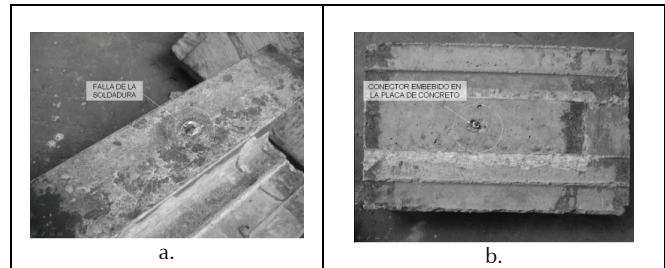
Falla de la soldadura. a) Ruptura de la soldadura en la base del conector. b) Conector embebido en la placa de concreto
